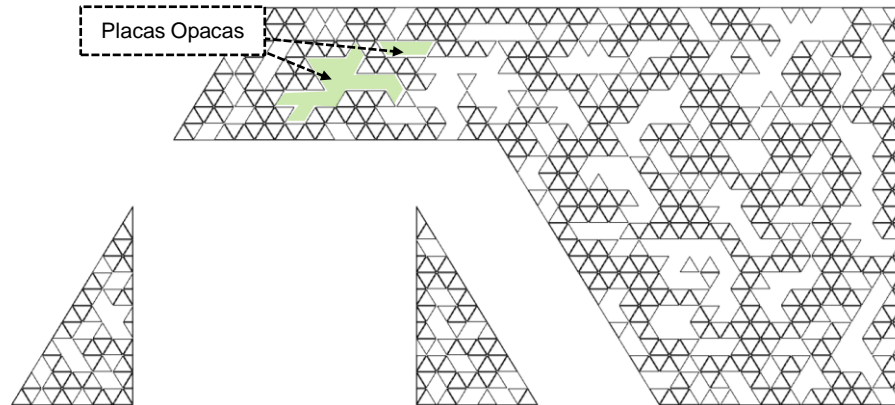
Plancha Perforada, Malla 1, Muro Acristalado, Fase 3
